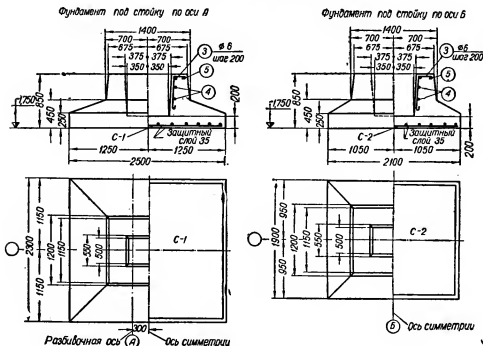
Конструкция фундаментов под стойки по осям А и Б.
